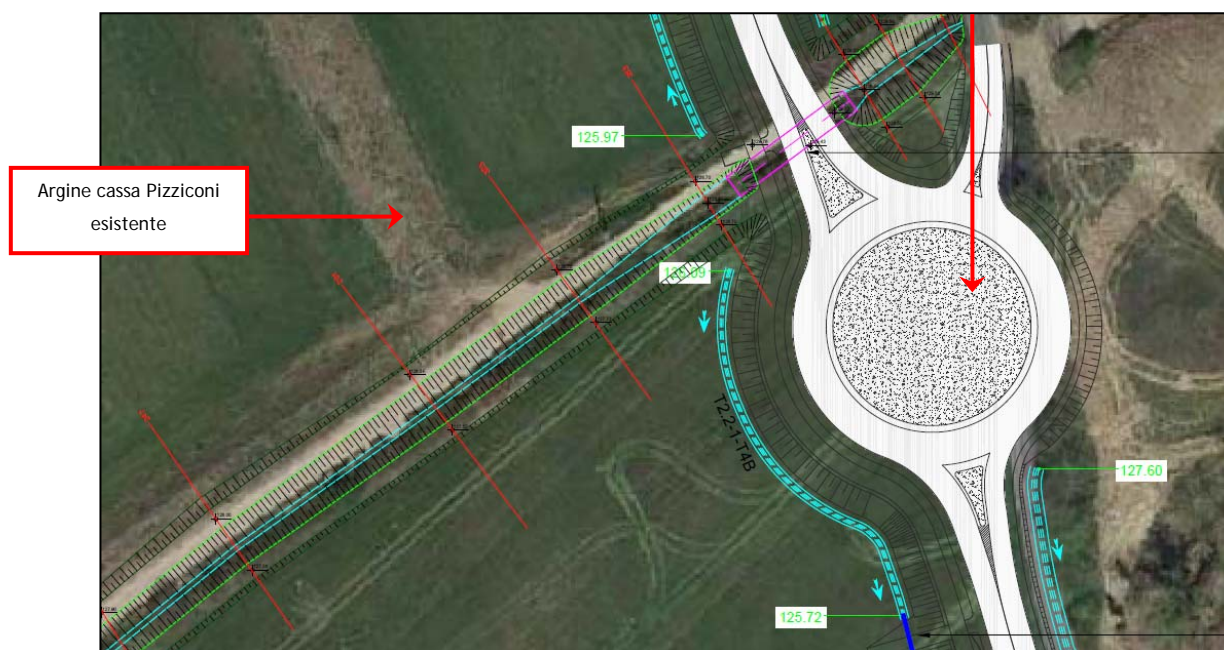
Borro Volpaie estratto da planimetria di progetto.
